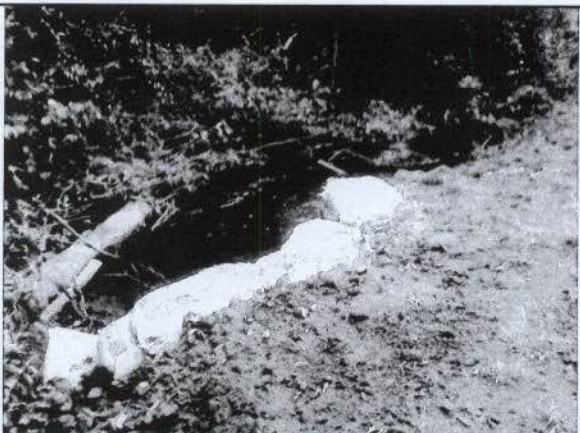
Acesso às torres 793-1 e 793-2 – estrutura apresentando estado precário de conservação.
